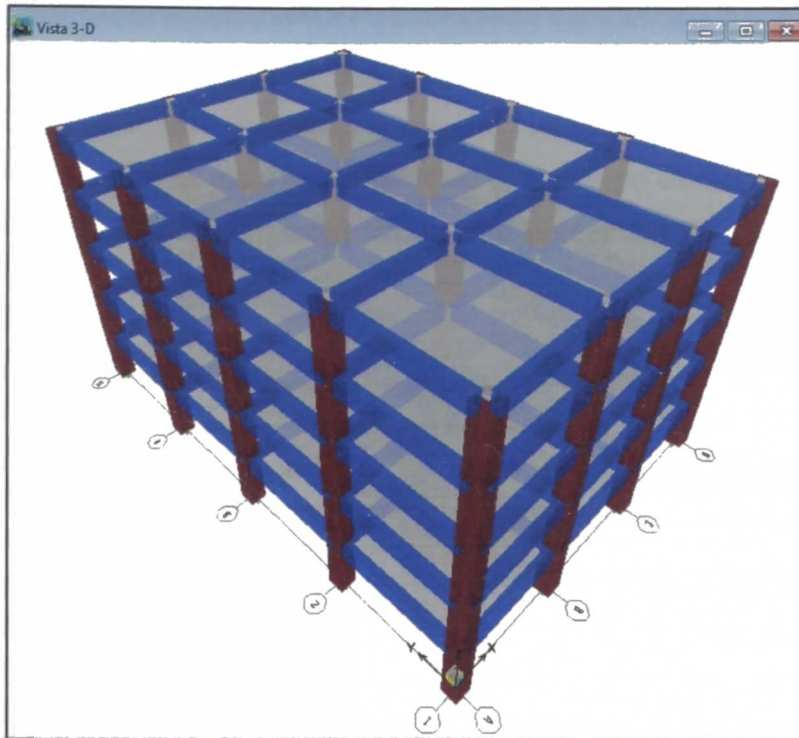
Vista en elevación de la estructura de 5 pisos, tipo 4
